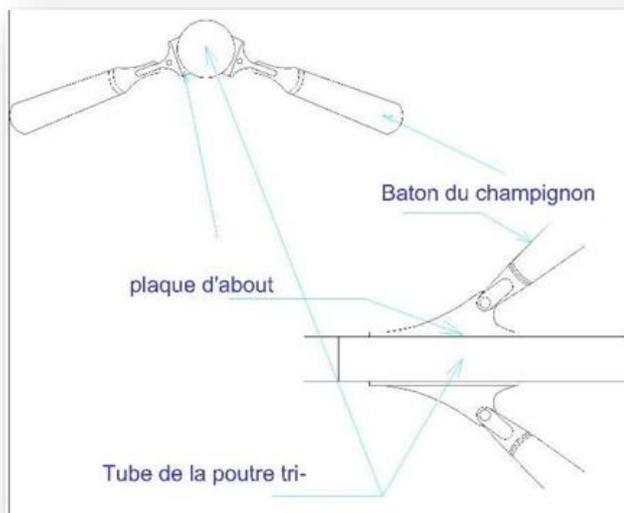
Détail des nœuds entre poutre et poteaux en profilés (ABN Building Corporation.com)
